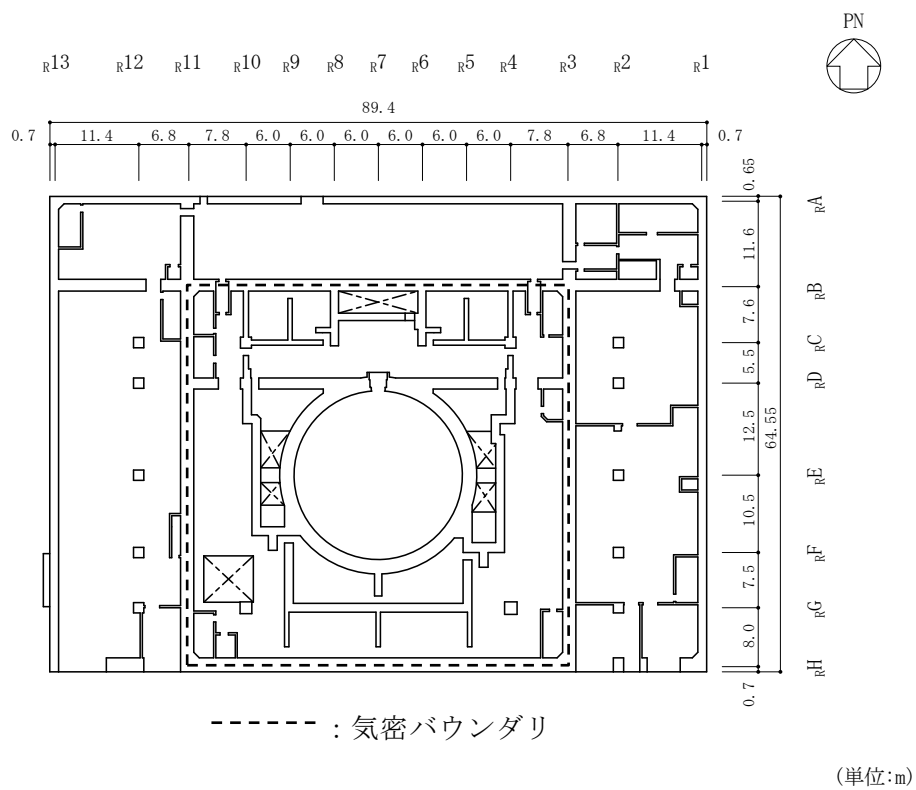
(4) 原子炉建物原子炉棟（二次格納施設）の概略平面図（EL 23.8m）
